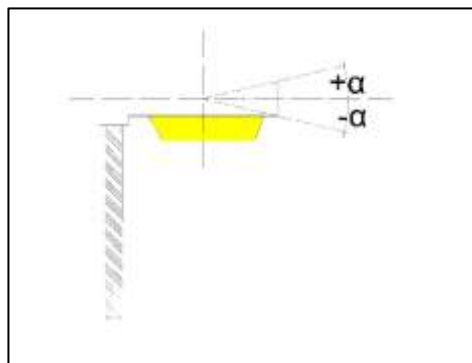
Apparecchi stradali per tipici da 1 a 14 (Tabella 10) - Inclinazione apparecchio nel sistema di fissaggio testa palo
